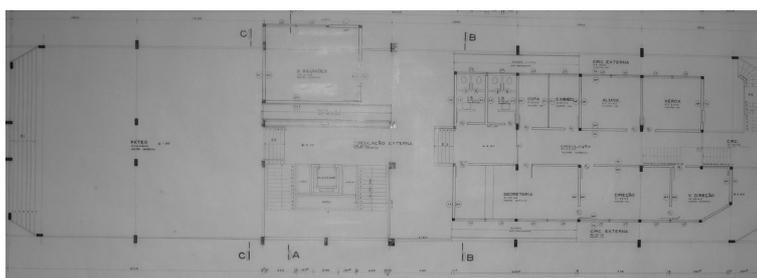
Planta do pavimento térreo de um bloco-módulo padrão de três pavimentos [1977].
